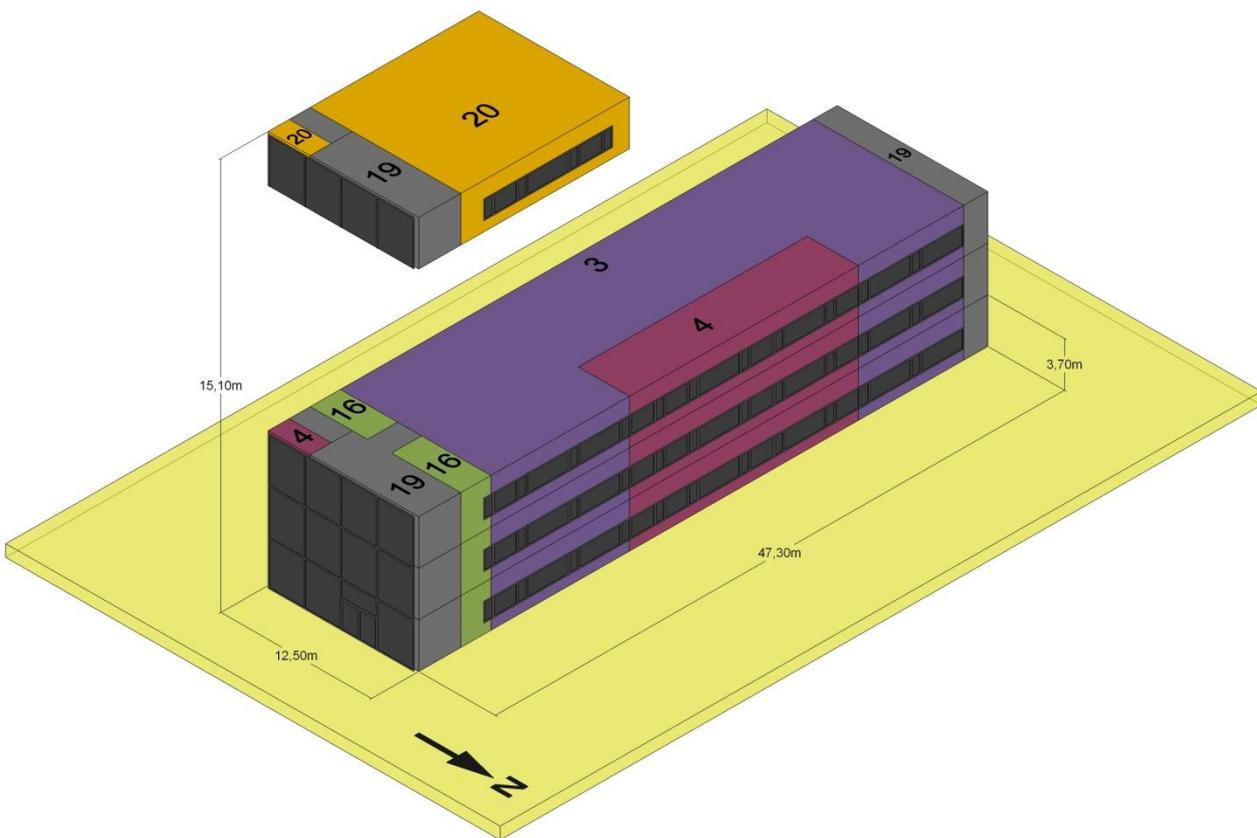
Büros - klein - Darstellung Zonen - Ansicht Nord-Ost
